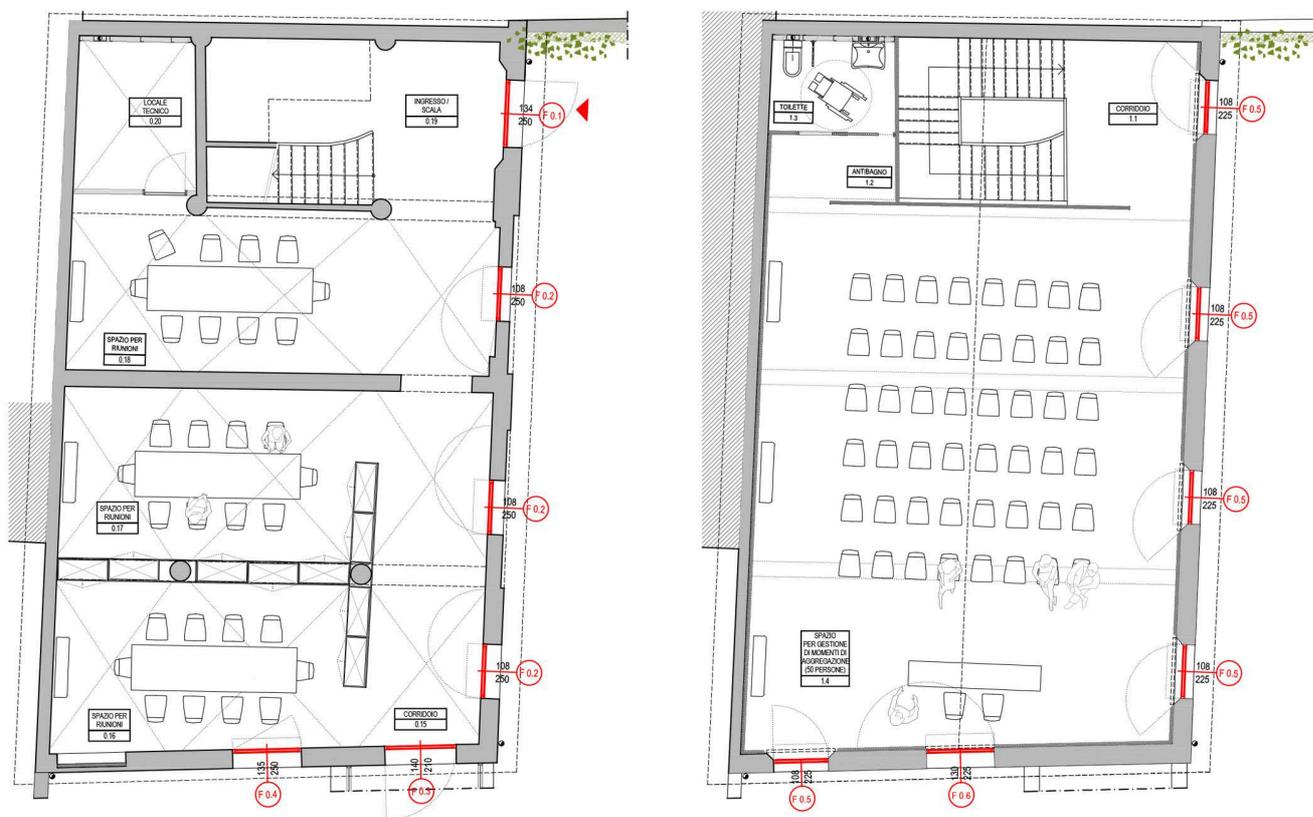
Pianta piano terra e piano primo delle Scuderie, in cui in rosso sono segnati i serramenti oggetto di miglioria
